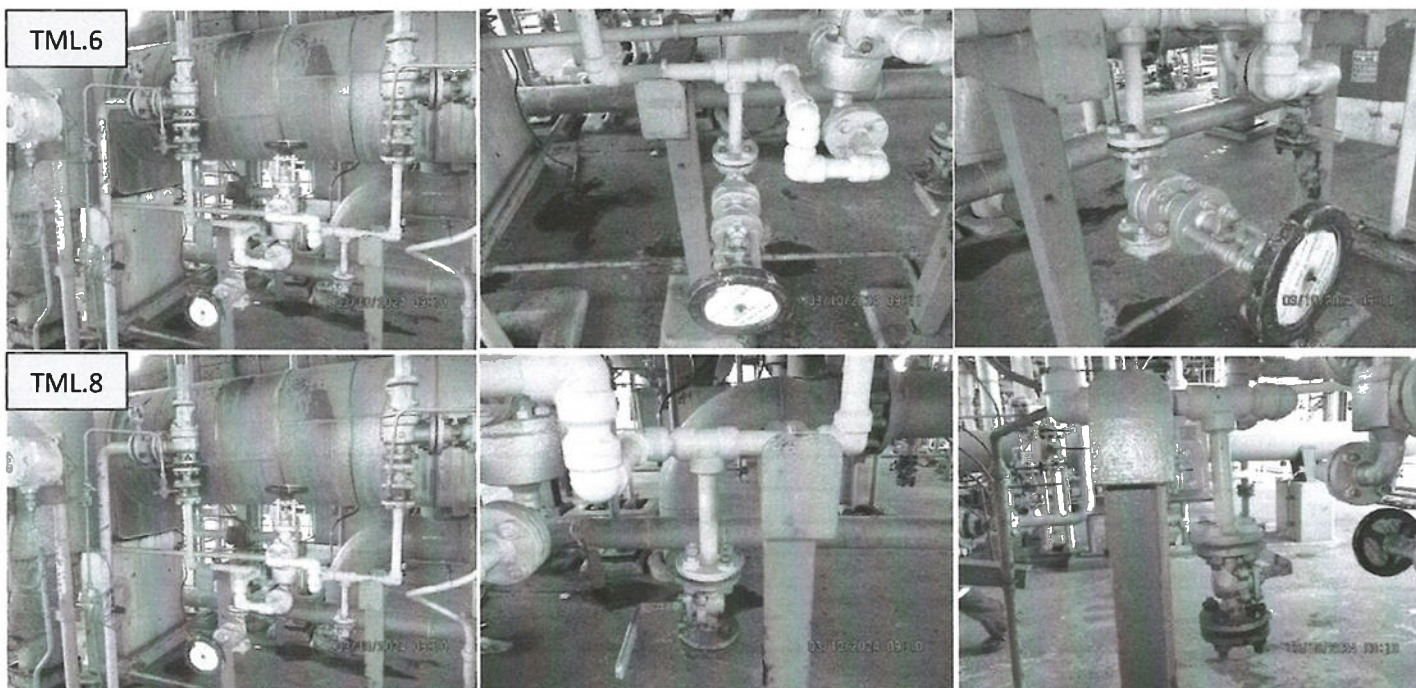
ภาพแสดงความเสียหาย Pipe line drain พบ Slightly corrosion บริเวณ flange
